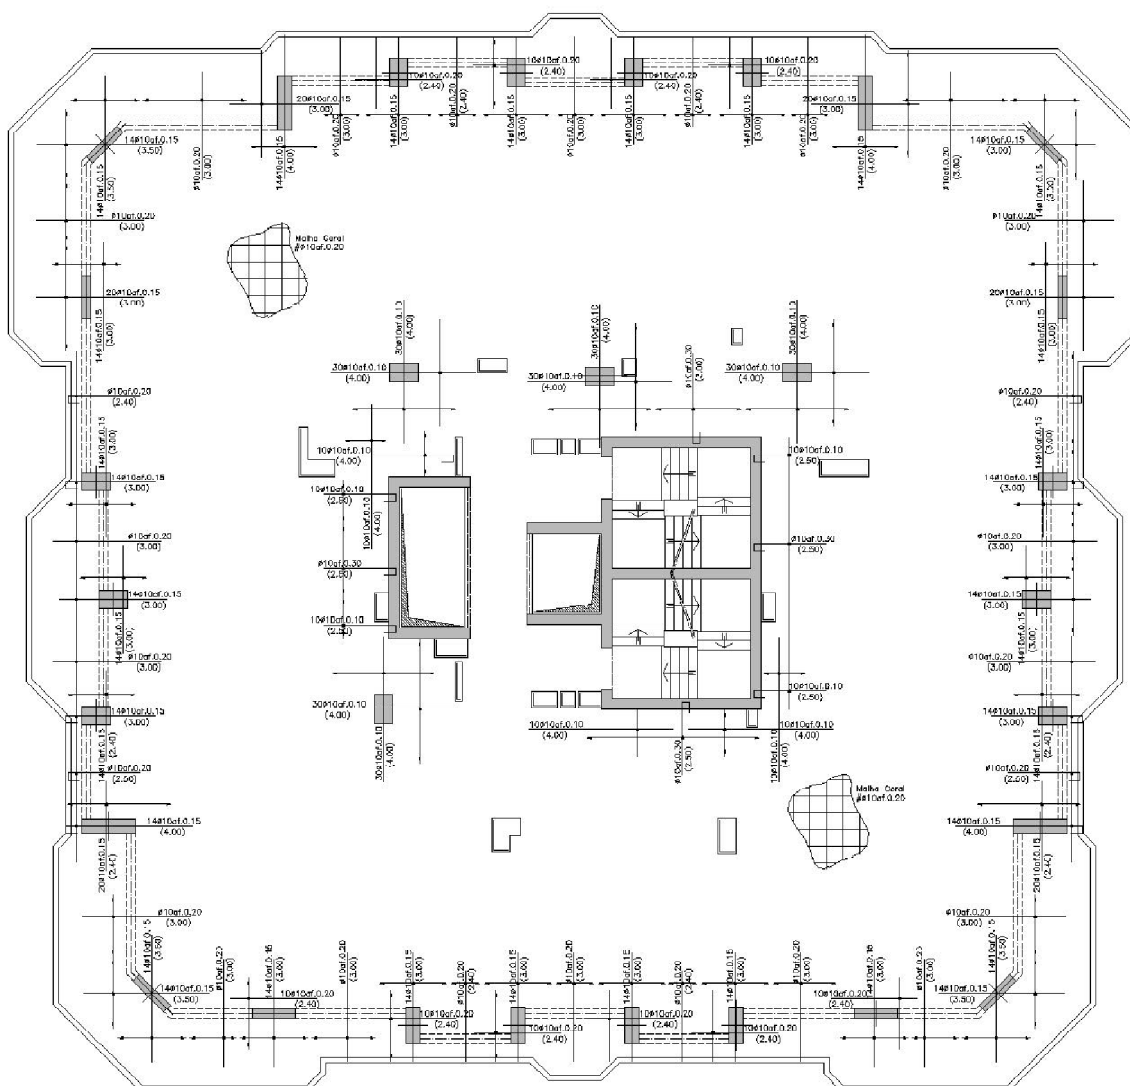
Desenhos de armaduras inferiores da laje do piso tipo.
